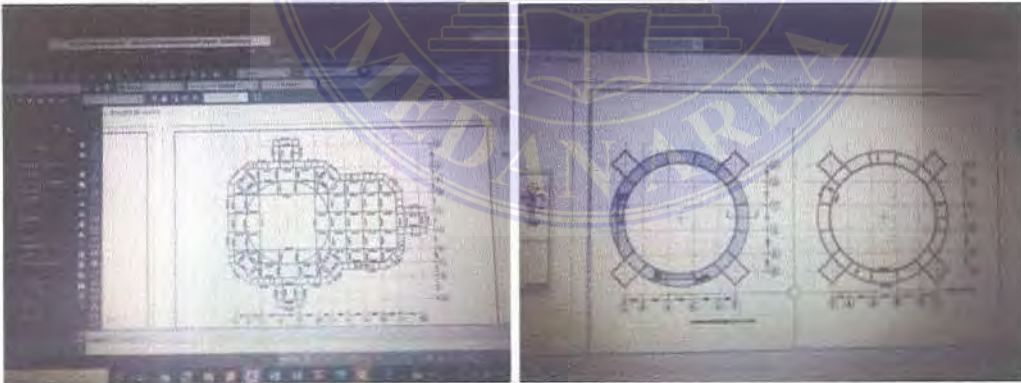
Pengerjaan Denah Kolom Masjid
